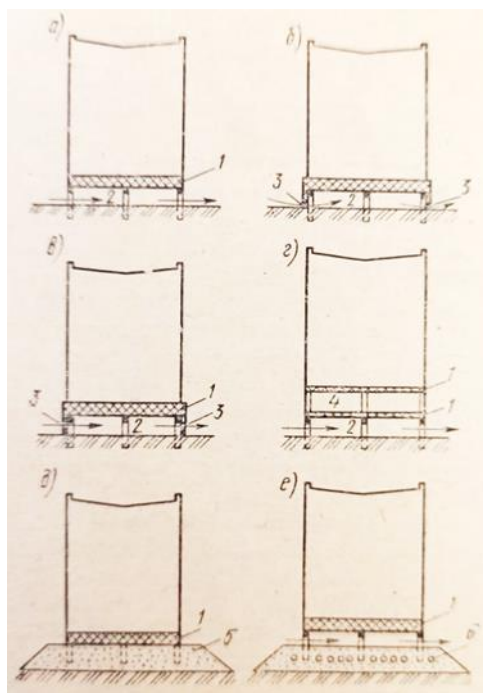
Способы сохранения вечной мерзлоты под фундаментом: а – открытое нерегулируемое подполье; б, в – открытое регулируемое подполье с продухами в нижней и верхней частях; г – подполье и технический этаж; д – подсыпка грунта; е – искусственное ограждение; 1 – утепленное перекрытие; 2 – вентилируемое подполье; 3 – продухи; 4 – технический этаж; 5 – подсыпка; 6 – трубы системы искусственного охлаждения.
